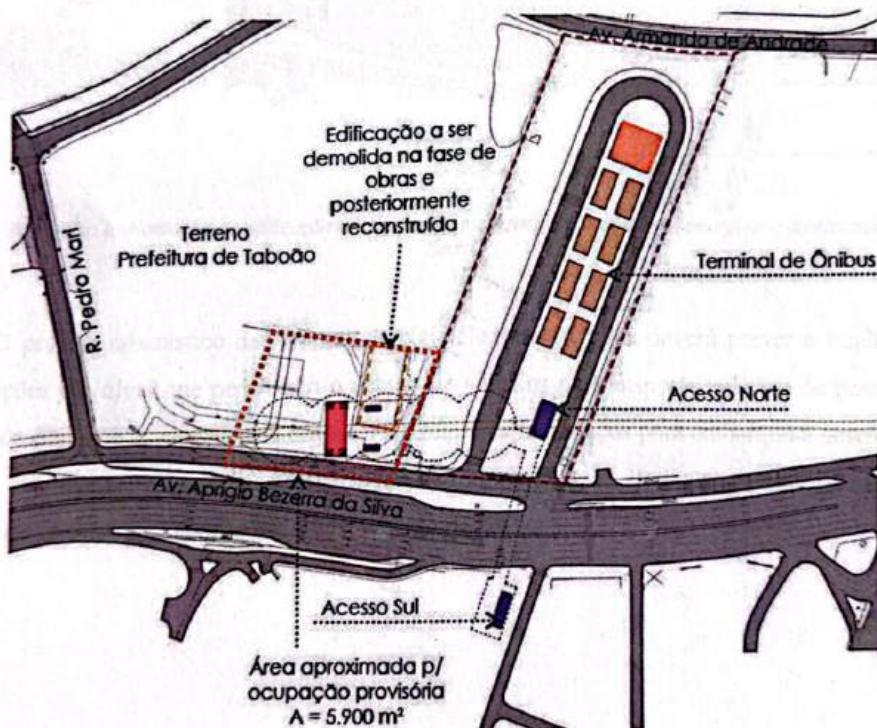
Área para ocupação provisória, durante fase de obras da Estação Taboão da Serra.
